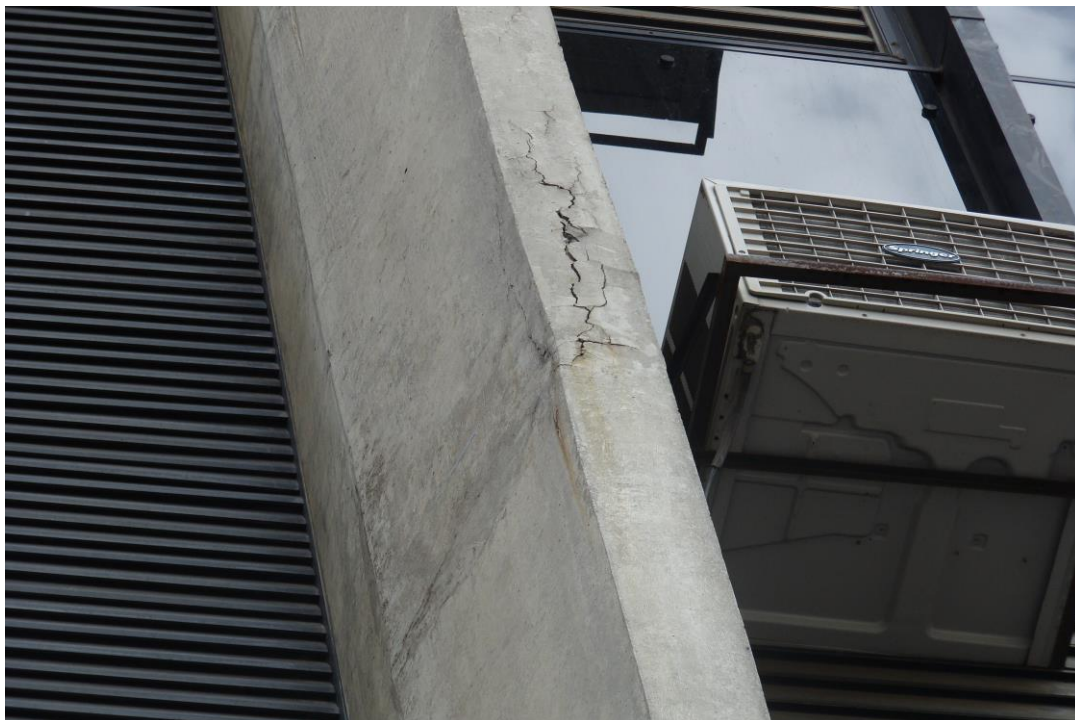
Armadura exposta pilar P12 (2º pavimento) (02/03/2021)
